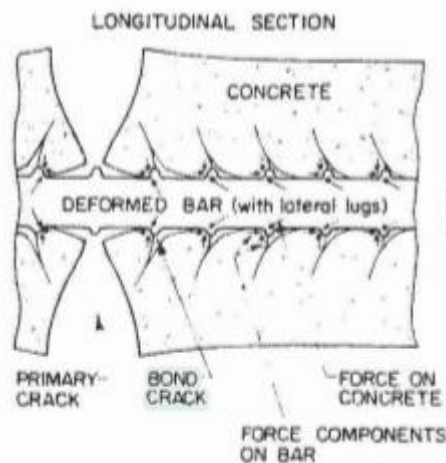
Fendas de ligação internas (adaptado de [41])
